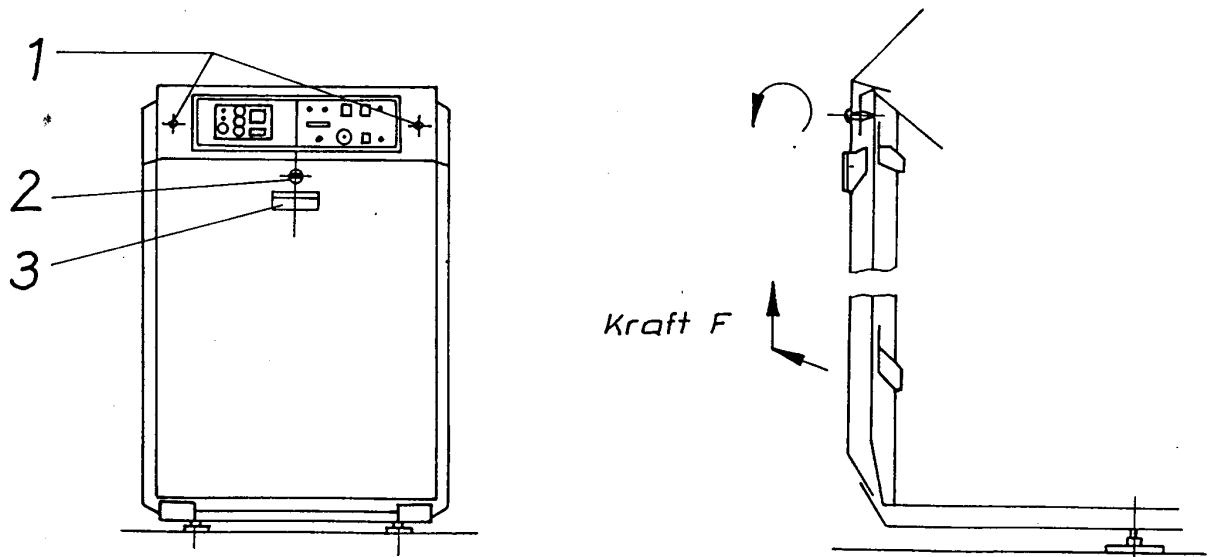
Demontage Kesselverkleidung - Vorderblech / Installationsraum
